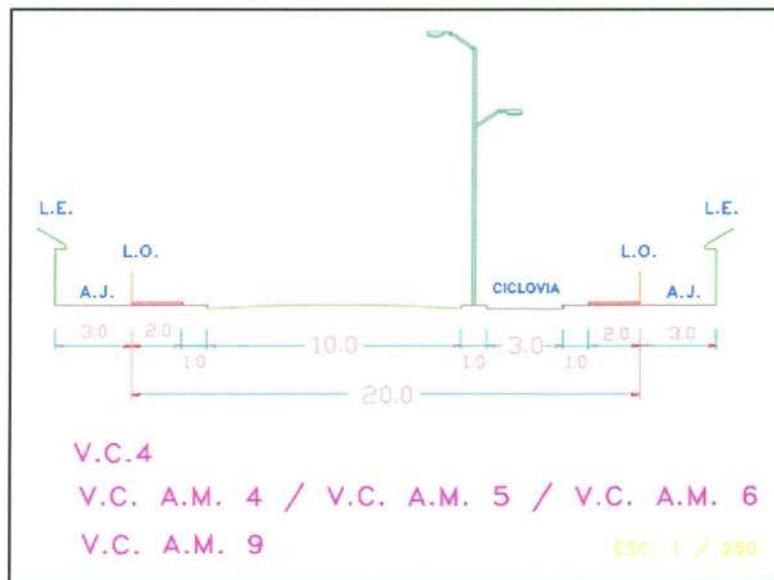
Perfil Vial V.C.A.M.4 Plano Vial Modificación del Plan Regulador de Iquique.
